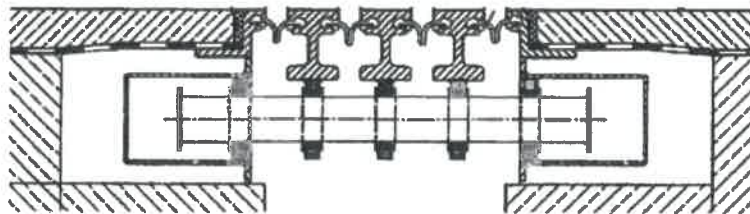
Sectiune transversala rost de dilatatie modular cu traversa, pentru suprafata pietonala. Figura prezinta dispunerea traversei pentru ghidaj.
